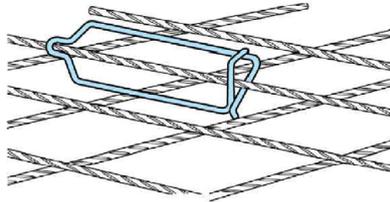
Einhängen wie dargestellt unter den oberen Bewehrungsstab.
